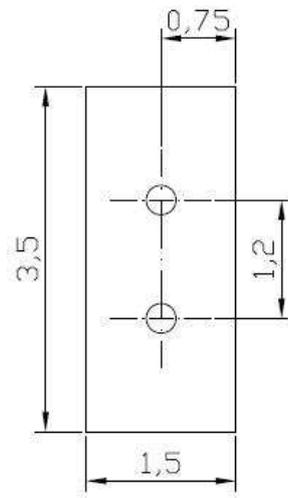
Distribución en planta de las luminarias de los baños 5 y 6.
